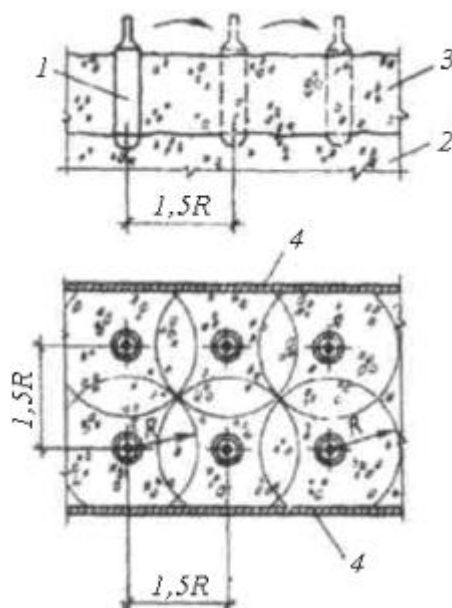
Виброуплотнение бетонной смеси: 1 – рабочий орган вибратора; 2 – ранее уложенный слой бетона; 3 – укладываемый слой; 4 – опалубка
